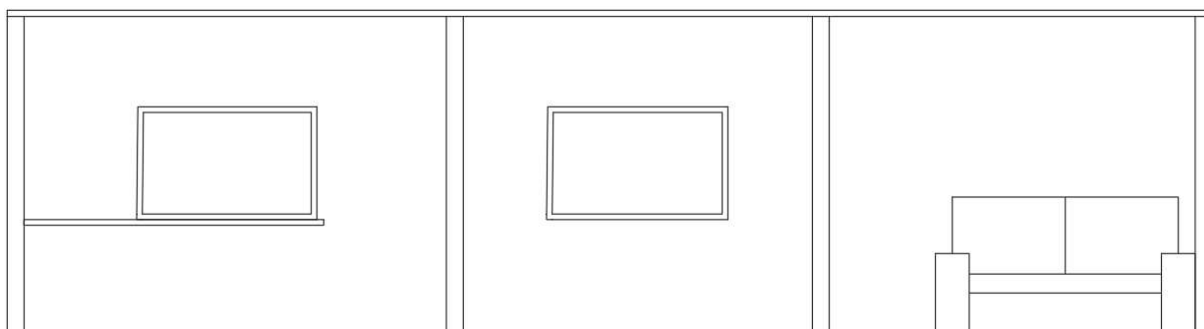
Corte utilizando ferramenta do Autocad finalizado
